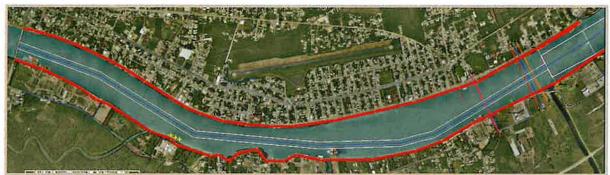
Vista en Planta del Canal de Navegación Aguas Arriba entre los cadenamientos (5+400 Al 10+450)
